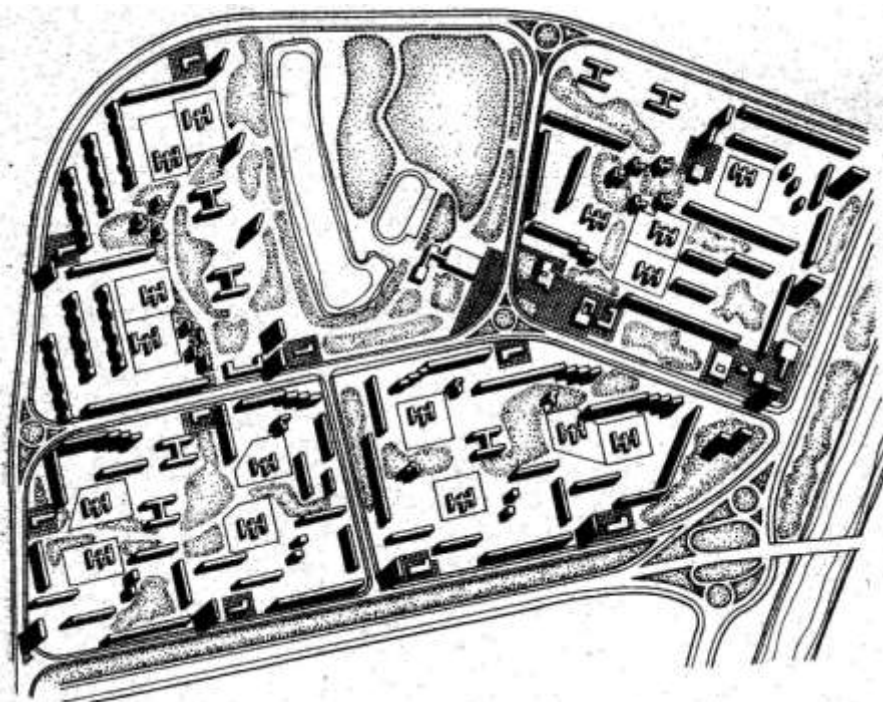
Схема планування та забудови житлового району Березняки (м. Київ)
